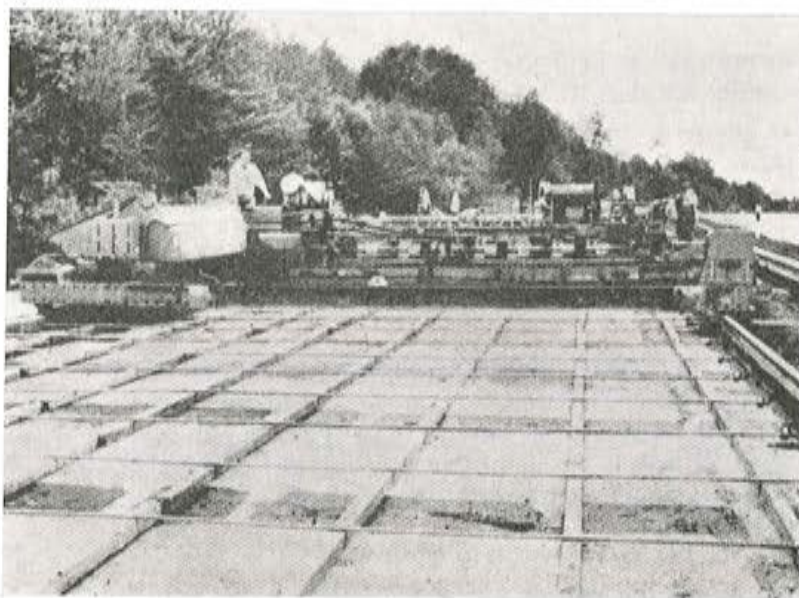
Hormigonado de una losa de pretensado interno, utilizando "barras" de hormigón.
